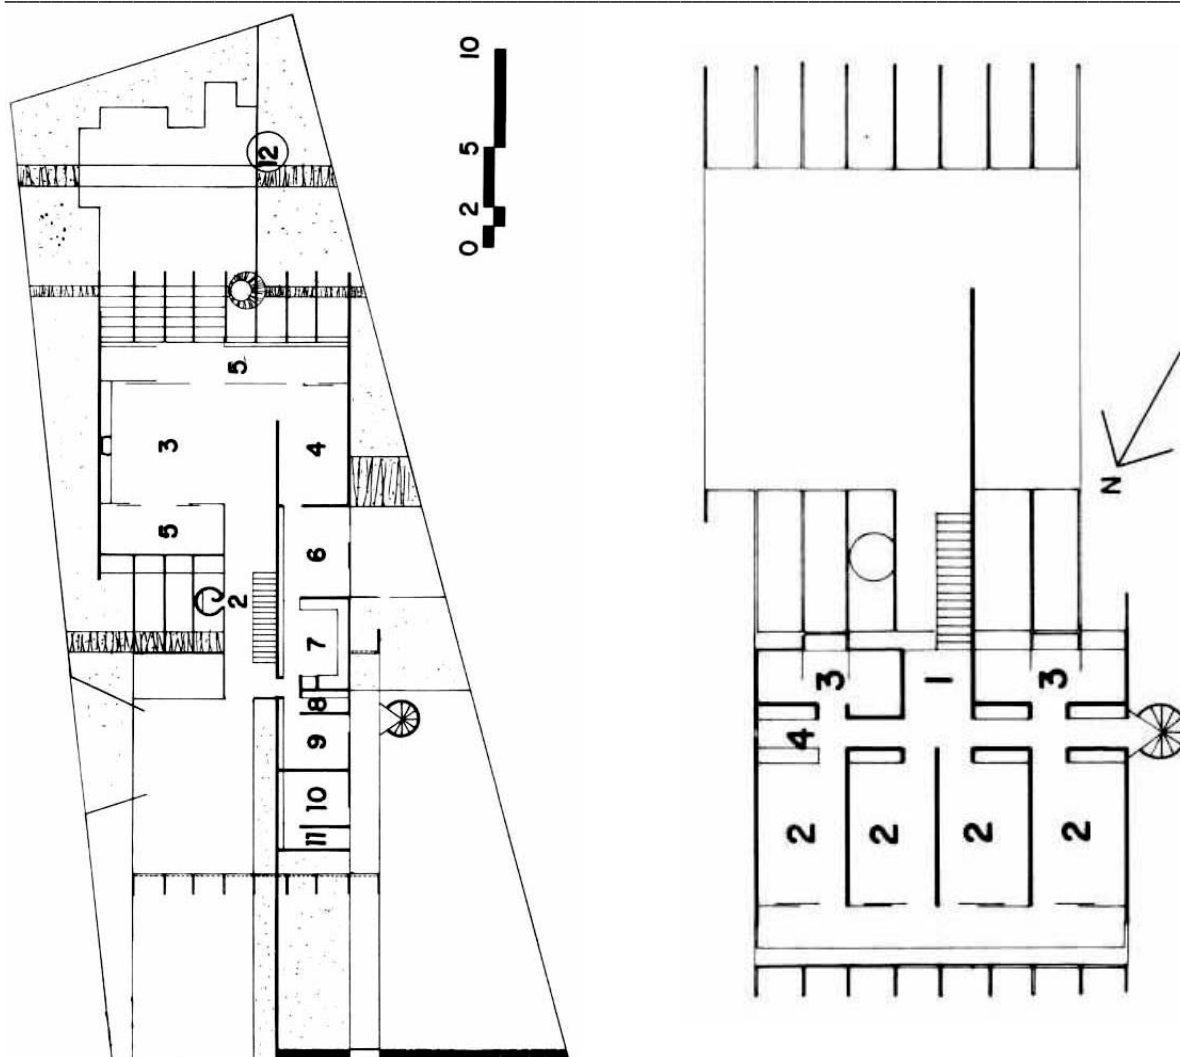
Planta Térreo: 1) abrigo; 2) hall; 3) estar; 4) Jantar; 5) terraço; 6) refeições; 7) cozinha; 8) despensa; 9) lavanderia; 10) q. empregada; 11) BWC; 12) churrasqueira.
